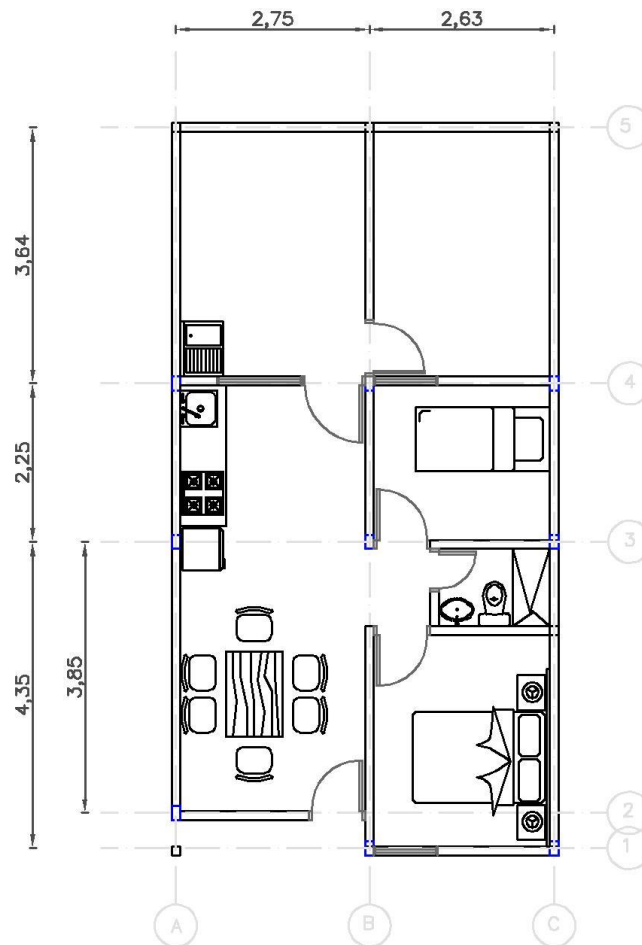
Diseño Arquitectónico Casa Guatiguara Primera Planta
